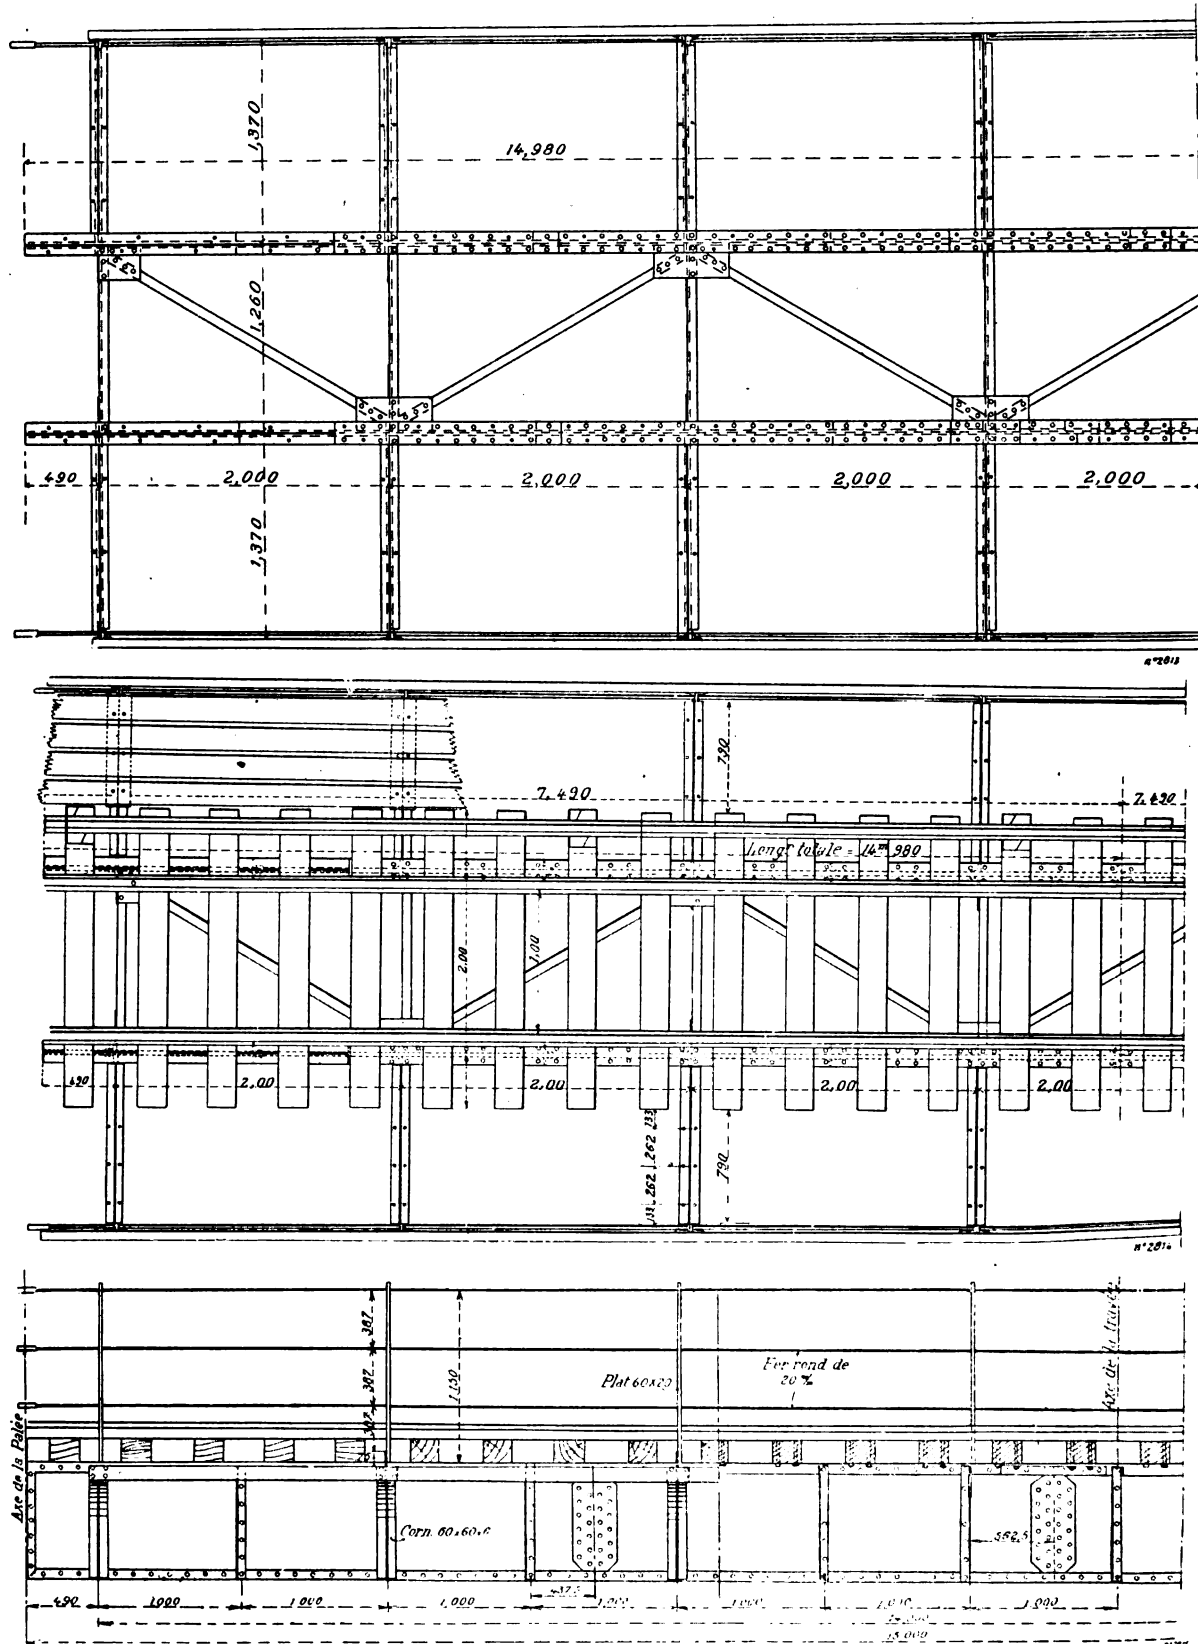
à 30. — Demi-plan d'ensemble et élévation longitudinale d'une travée de 15 mètres.
